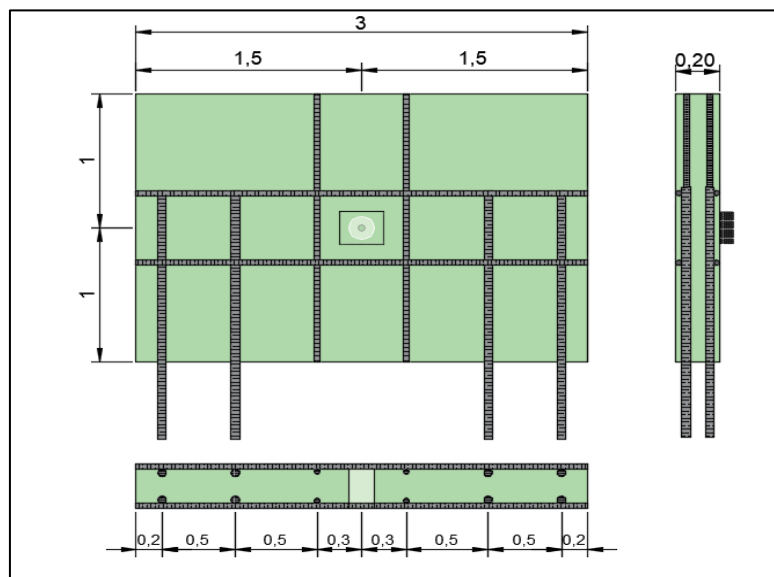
Esquema panel prefabricado Modelo 2. Fuente: Propia
